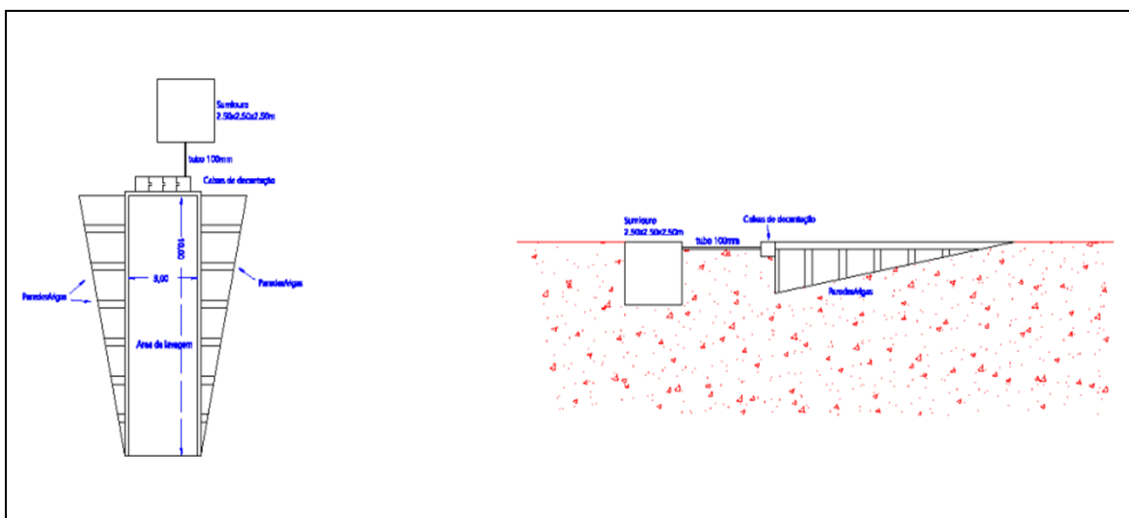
Sistema de separação de resíduos na lavagem do caminhão betoneira.
